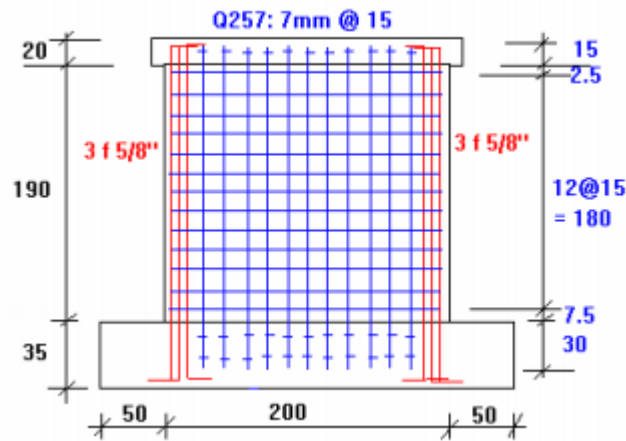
Esquema del refuerzo muro ME1. (Cardenas & Cutipa, 2009)
